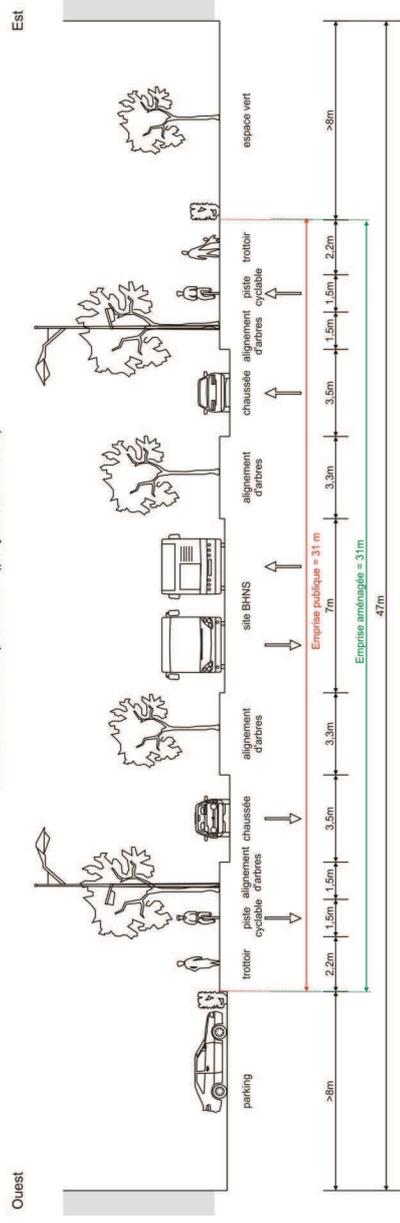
Situation projetée (coupe 29) avenue de l'Europe / section "Nord"
